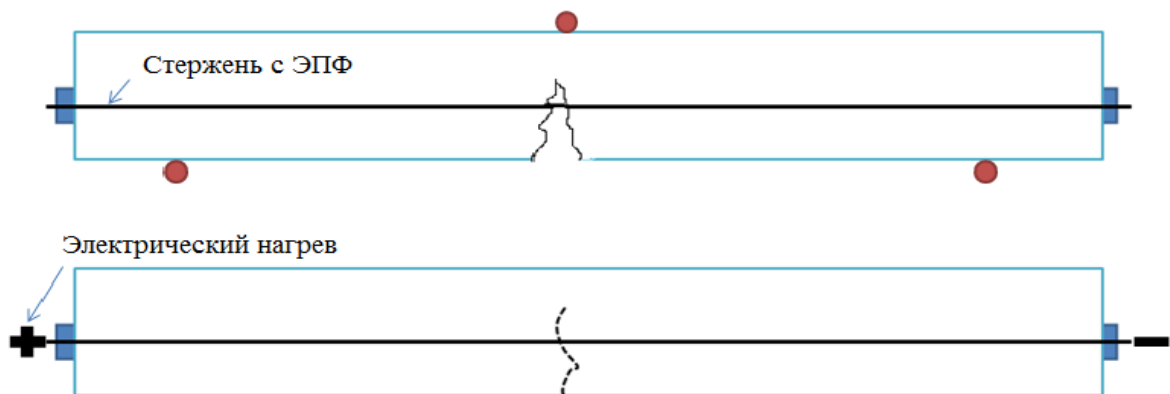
Восстановление плиты перекрытия с применением арматуры из материалов с ЭПФ, Университет Хьюстона [149]
